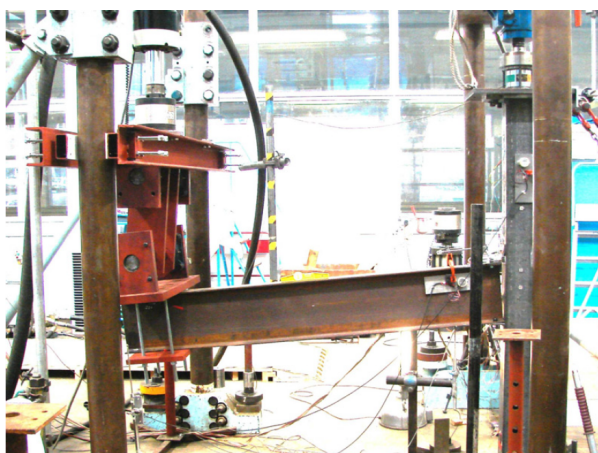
Испытательный стенд и схема испытуемого узла.
